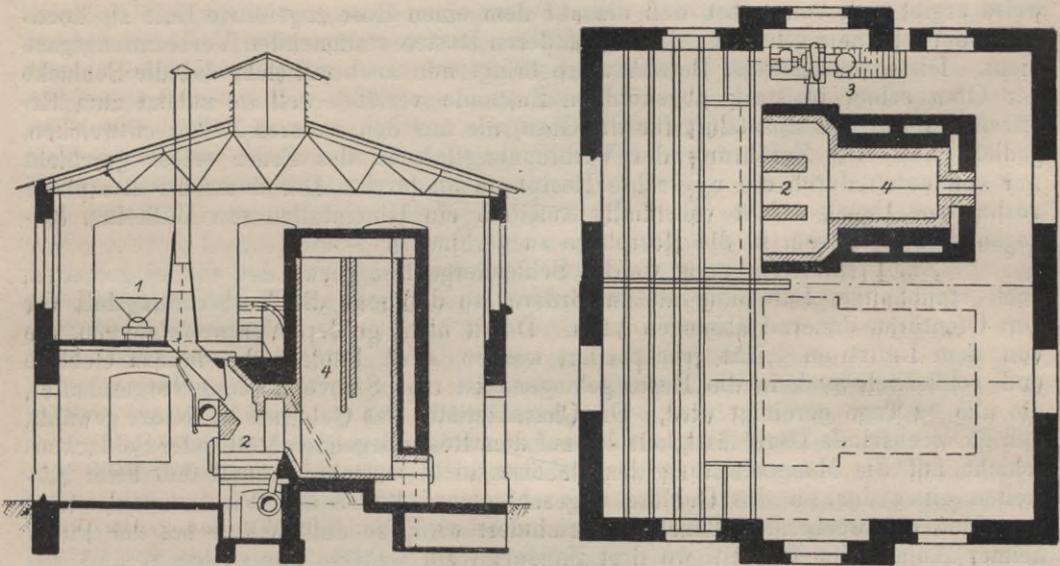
und 3. Querschnitt und Grundriß der Puchheimer Müllverbrennungsanlage.
